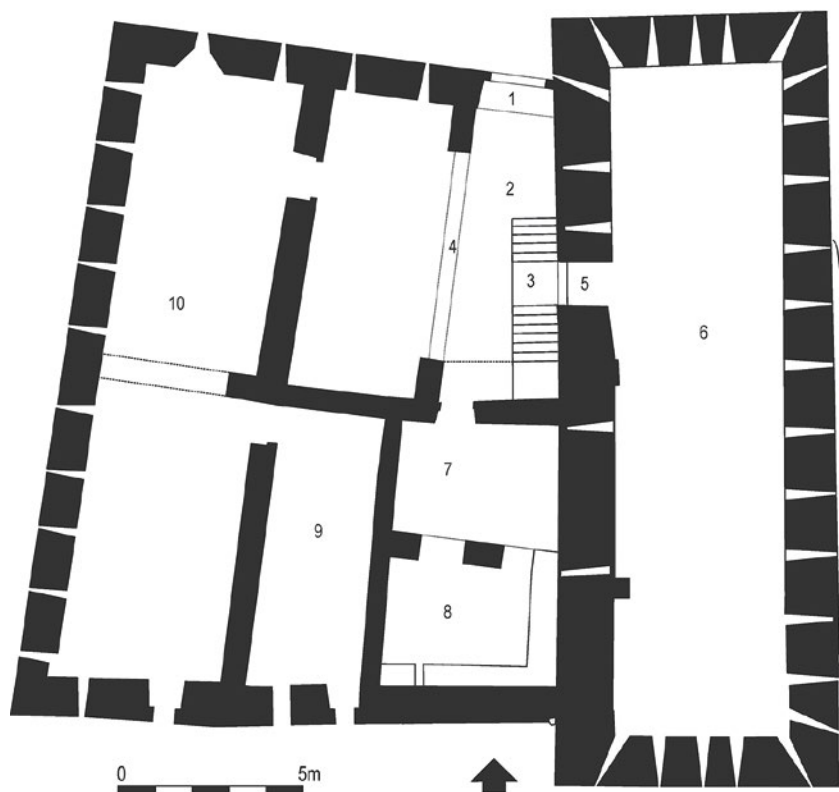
Planta baixa restituïda del palau gòtic. 1). Porta principal d'accés al recinte. 2) Antic pati, avui cobert. 3) Escala actualment molt reformada que pujava a la planta noble i també a la porta d'accés a l'edifici del segle XII. 4) Arc de carpanell que tancava el pati per ponent. Actualment resta paredat però encara són visibles diferents elements que permeten endevinar la bona conservació tant de l'arc rebaixat com dels brancals. 5) Porta d'accés a la planta baixa de la torre. Es conserva pràcticament intacta excepte el llindar, que va ser reformat en el segle XV en projectar-se l'escala gòtica del pati. 6) Estança inferior del cos principal de la torre. Tret de l'extrem de migdia es conserva en excel·lents condicions. 7, 8 i 9) Noves estances creades a partir de l'ocupació de la meitat sud de l'antic pati. El núm. 8 correspon a la cisterna obliterada al segle XVII. 10) Cos occidental de la casa forta. Amb la reforma de finals del segle XV es paredava l'arcada de migdia.
